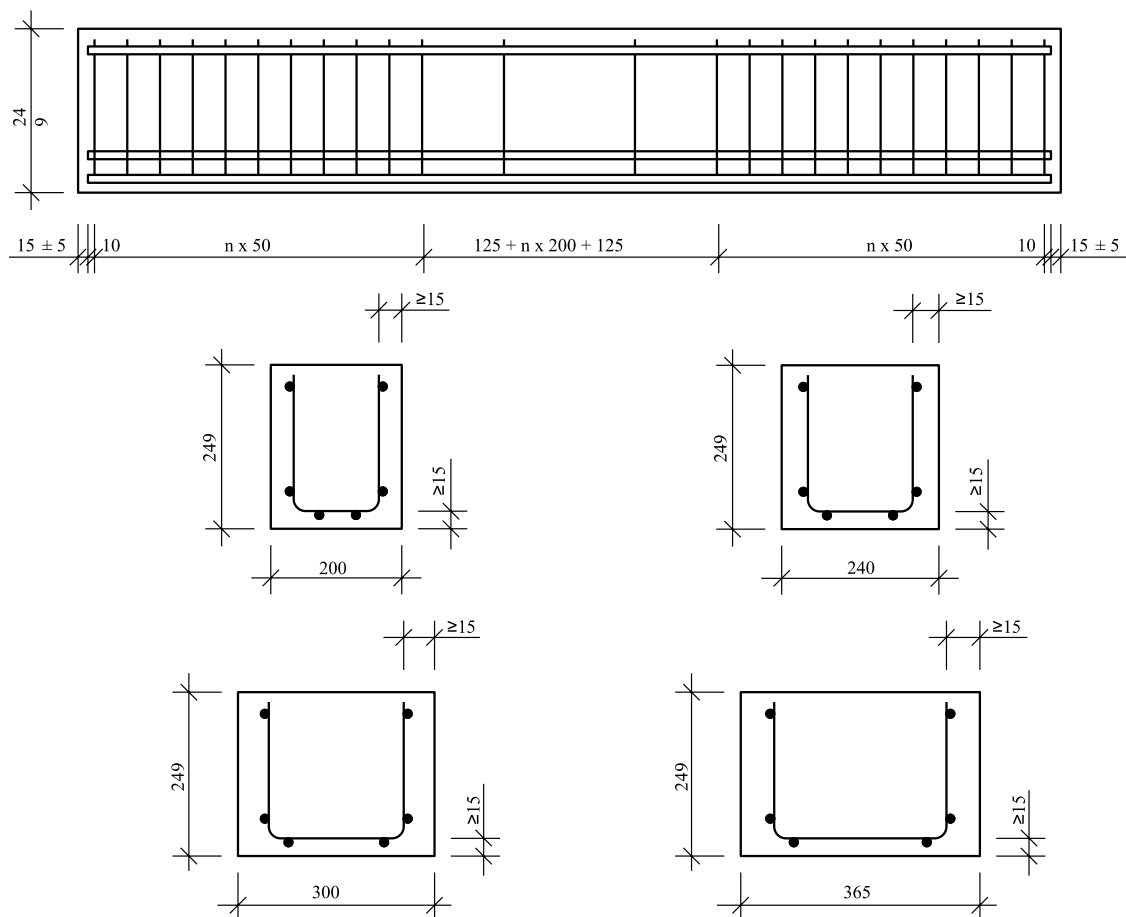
Армирование перемычек заводского изготовления из ячеистого бетона для стен из ячеистобетонных блоков [25]
